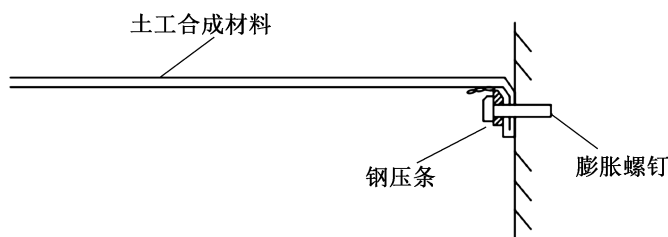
土工格栅与混凝土桥台连接示意图
